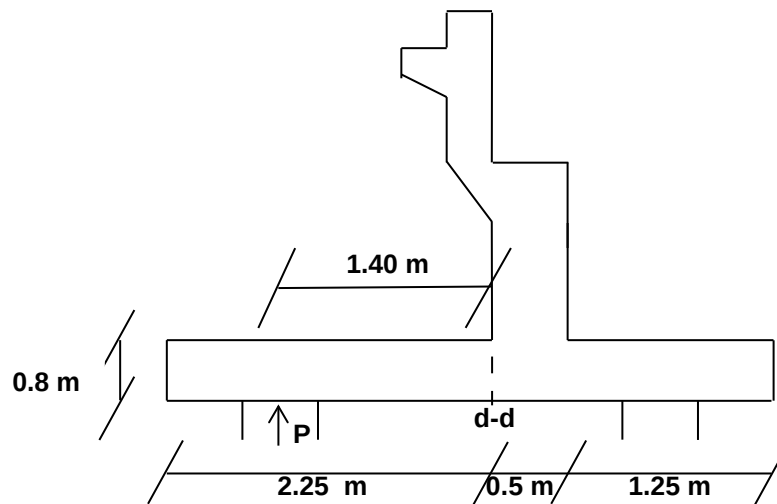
Acción de la fuerza del pilote sobre el talón de la zapata.
